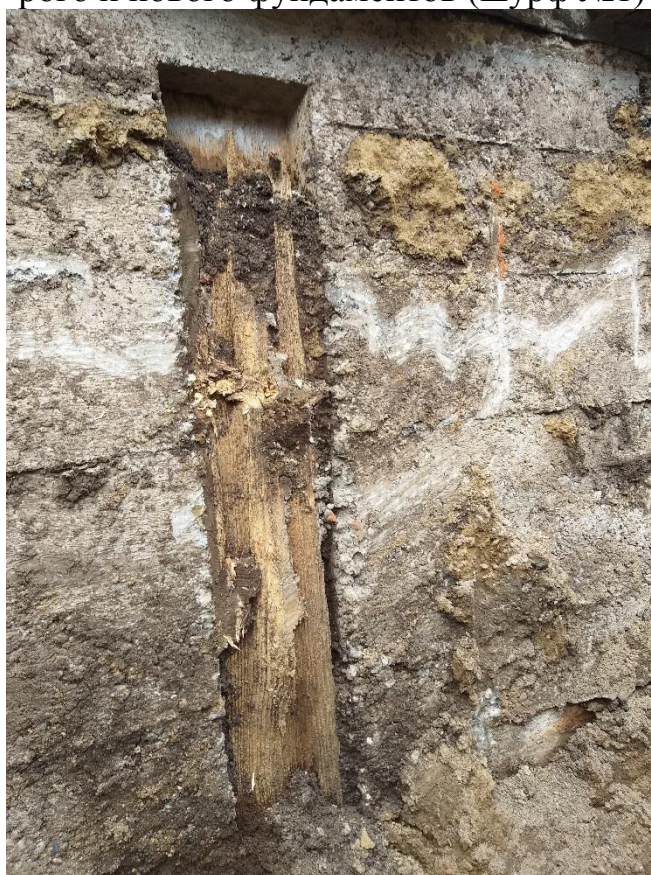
Вкрапление элементов деревянной опалубки в тело бетона фундамента (шурф №3)
